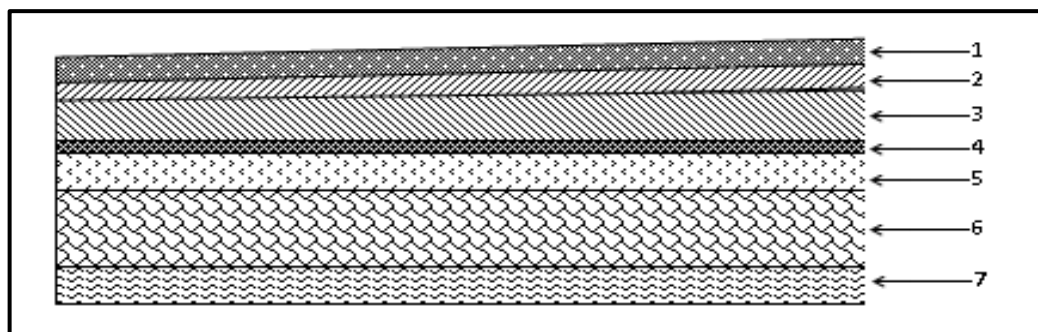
Coupe transversale du plancher terrasse inaccessible
